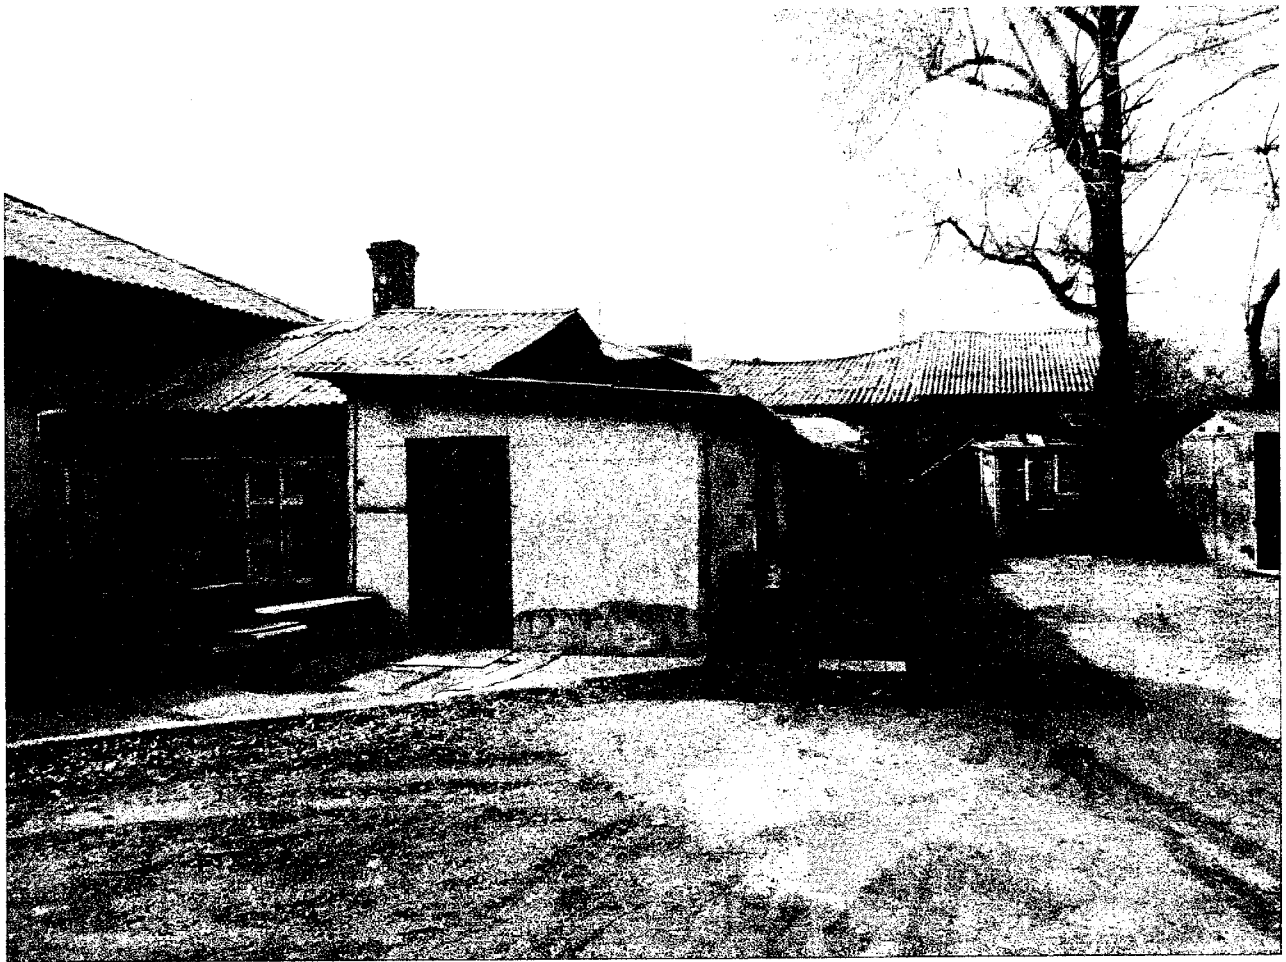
Боковой (юго-восточный) фасад дома, поздние пристрой к северо-восточному фасаду
